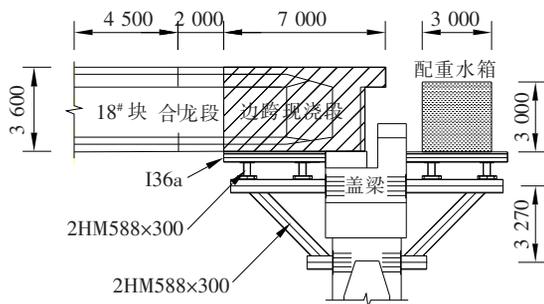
7 m 现浇段大悬臂托架布置示意图(单位:mm)
